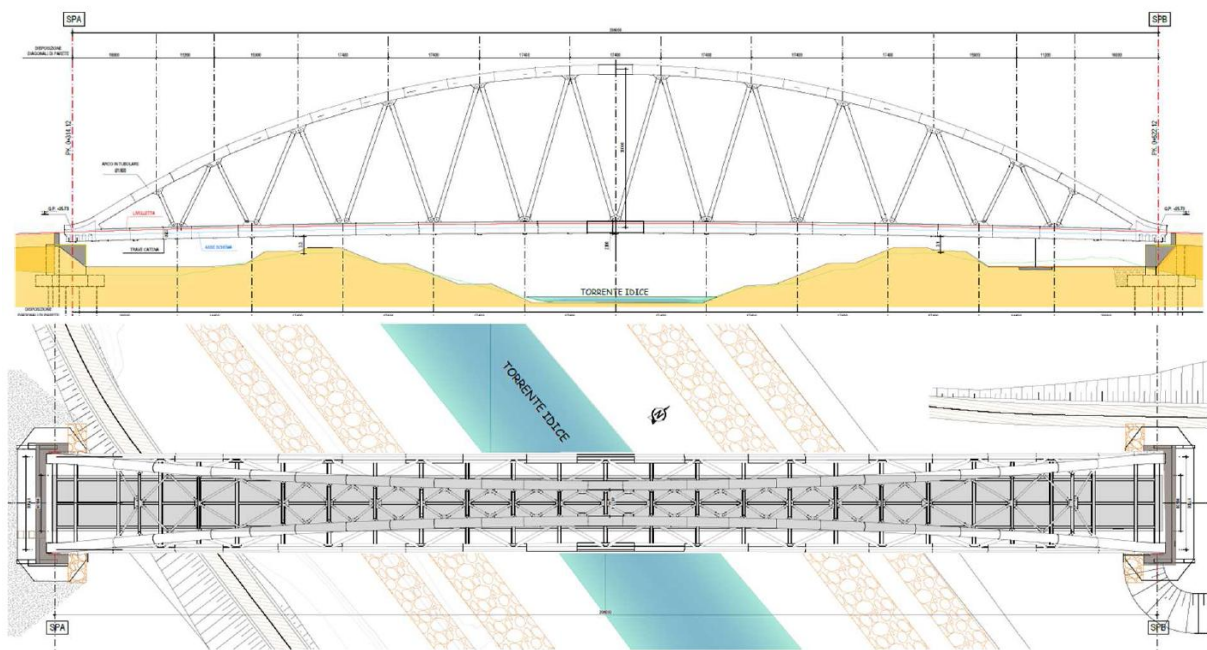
Profilo longitudinale e vista dall'alto del ponte (estratto tavola 24V25_PF_T_ST_702_r00)
